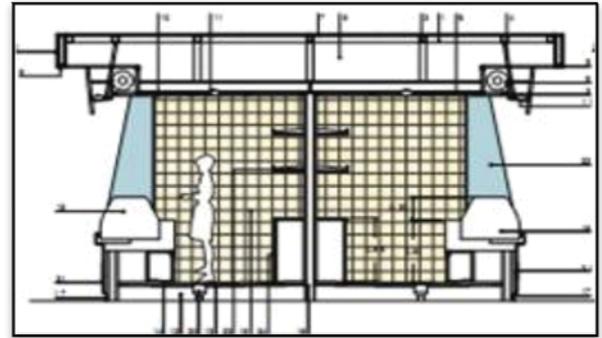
Procedimientos constructivos y tipología de los locales.
